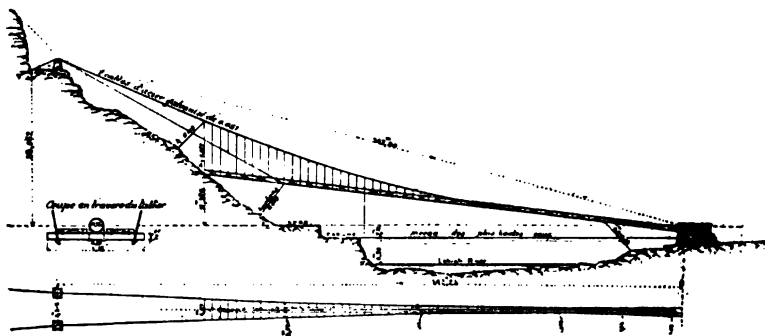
Pont portant une Conduite de Pétrole, sur le Lehigh.
